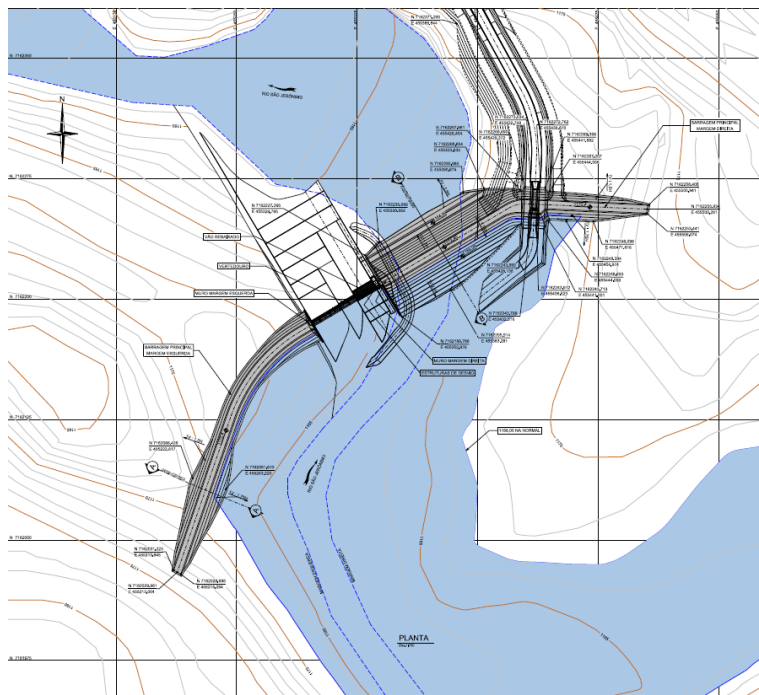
Planta do barramento principal da PCH São Jerônimo.
